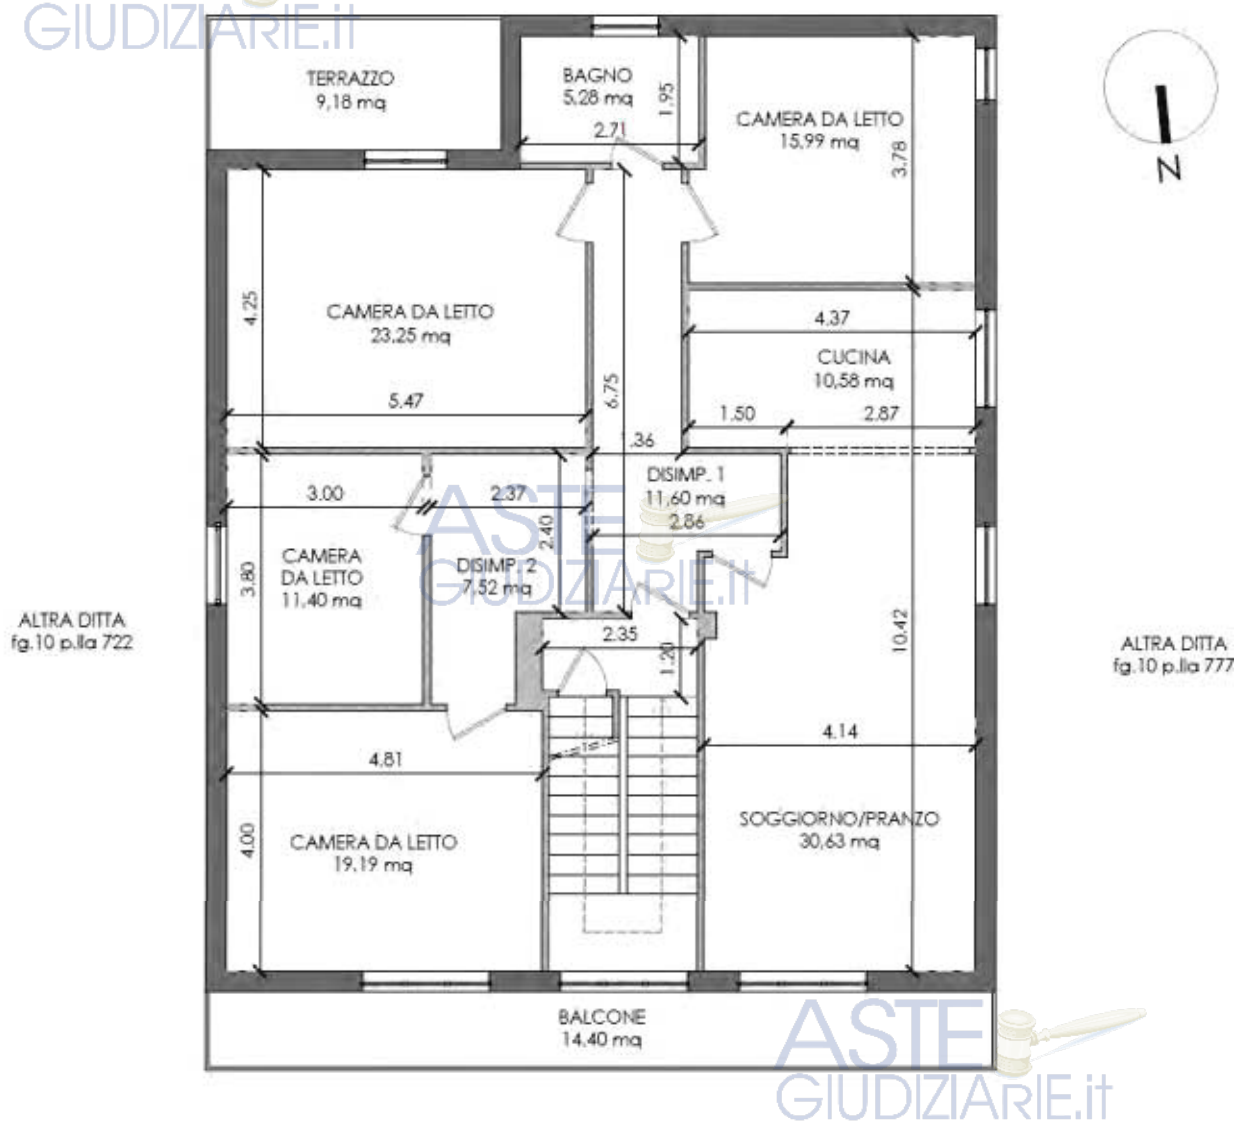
Rilievo Abitazione Lotto 1 Stato di fatto _ Abitazione pianta piano primo (Allegato 6D)
